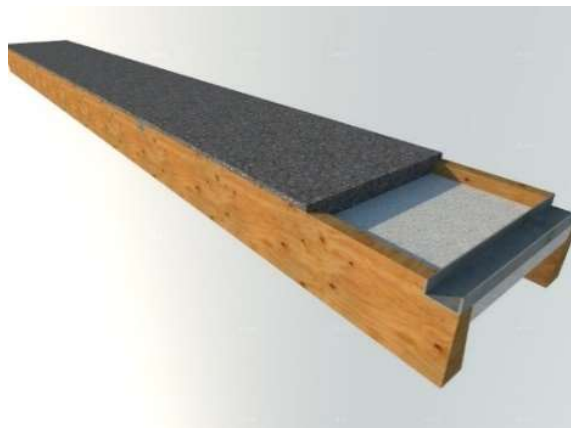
entwickelter Prototyp für ein Deckenelement aus Holz-Beton-Holzleichtbeton (Anmerkung: auf dem 3D-Schaubild wird die Betonplatte höher dargestellt, als in den Werkplänen. Dort werden die seitlichen Holzträger ebenfalls noch mit Beton überdeckt, was brandschutztechnische Vorteile hat)
